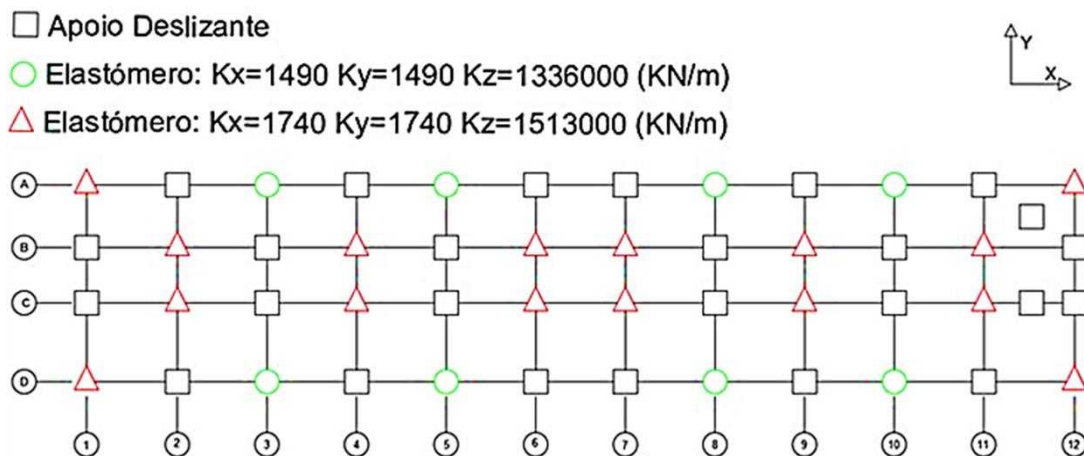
Esquema de Posicionamento dos Dispositivos de Apoio – Configuração Final.
